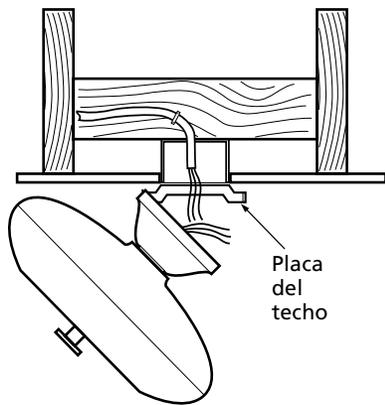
Ventilador armado colgando de los ganchos de la placa del techo
